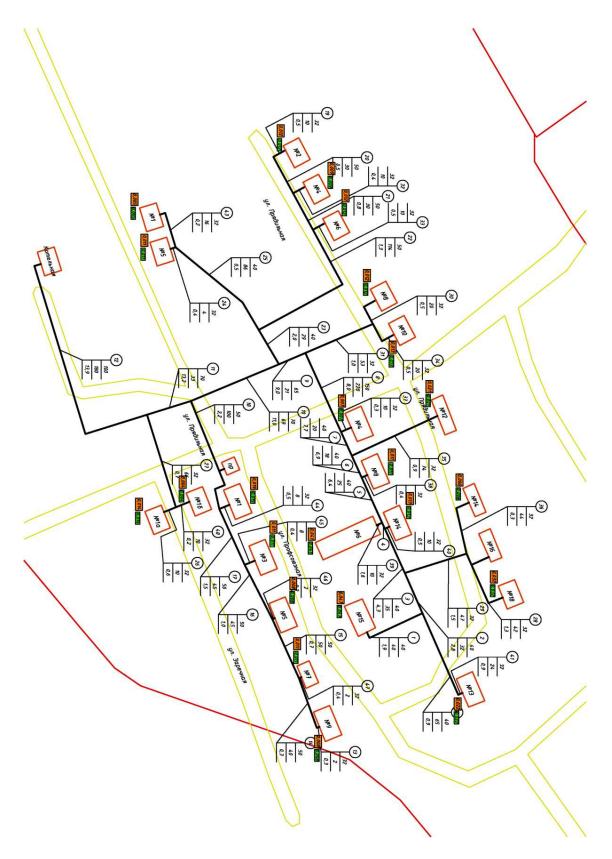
Схема сравнения расчётных и фактических тепловых нагрузок по котельной 6 д. Ерофеево
